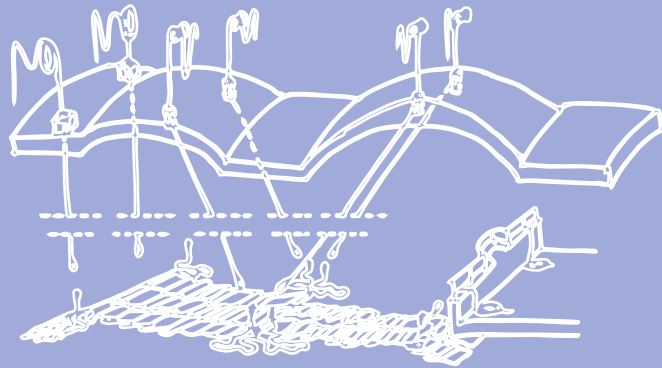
Montage im Kirchenraum, Anschlüsse im Dachstuhl
